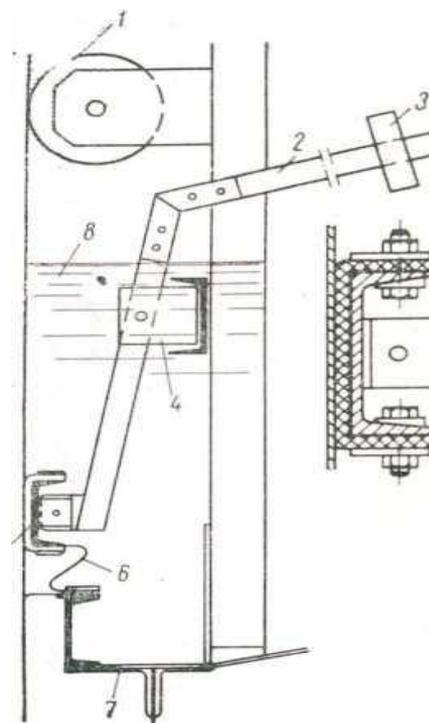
Поперечный разрез затвора с жидкостным уплотнением отечественной конструкции системы ВДК для сухих газгольдеров с цилиндрическим корпусом 1 — выравнивающий ролик; 2 — рычаг; 3 — противовес; 4 — опора рычага; 5 — прижимное эластичное кольцо; 6 — фартук; 7 — днище поршня; 8 — газгольдерное масло
